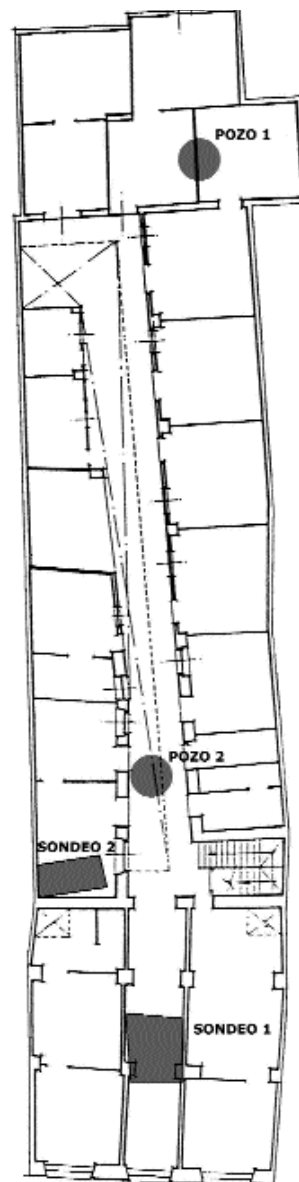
Plano de la estructura de la planta baja de la Casa Alta y situación de los sondeos 1 y 2, así como la localización de las estructuras 1 y 2 (pozos ciegos).
